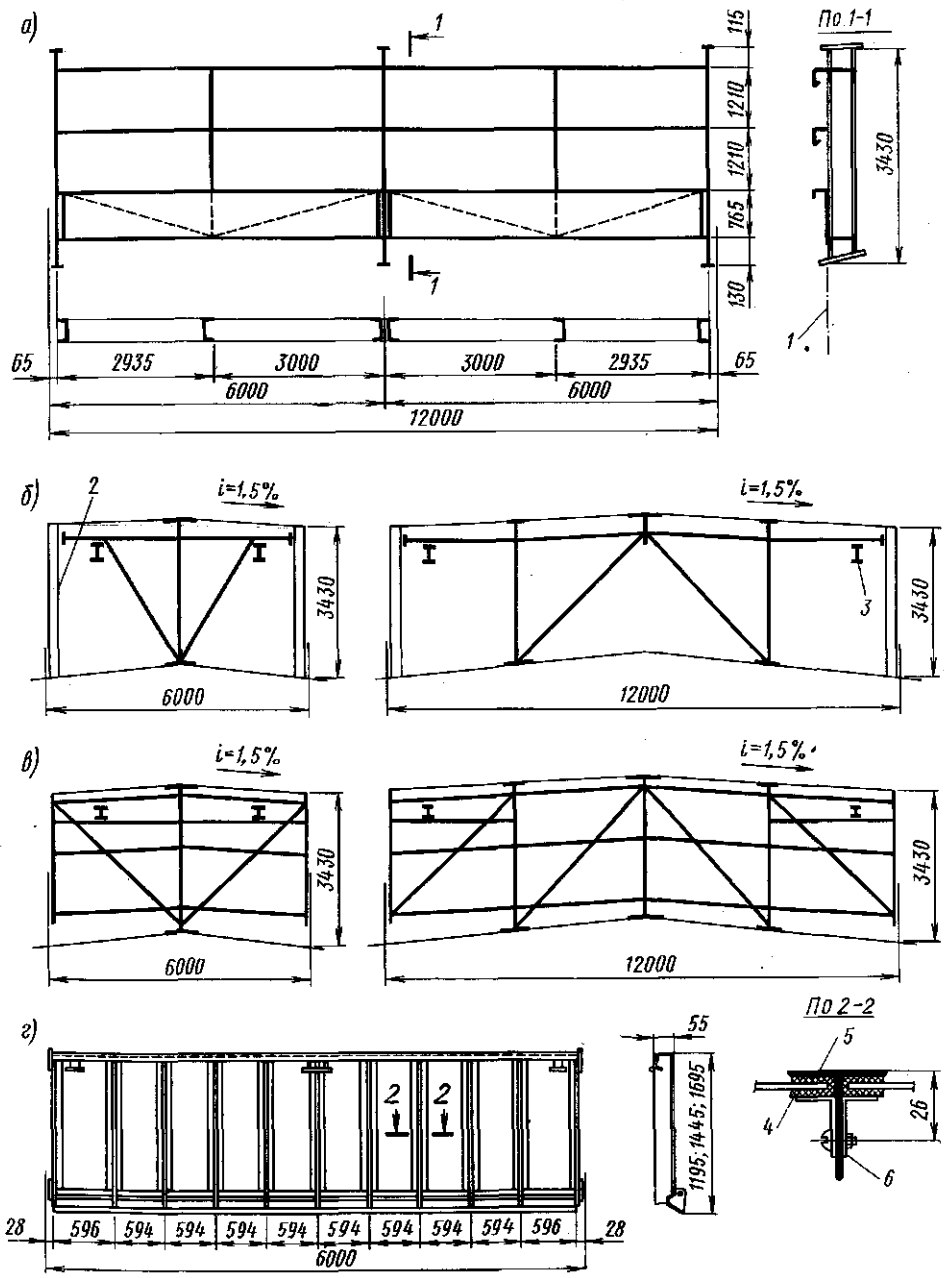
Схемы стальных конструкций прямоугольного фонаря:
